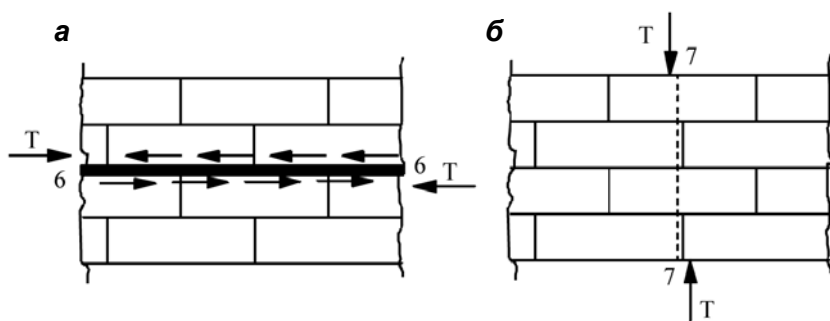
Растяжение кладки при изгибе по перевязанному сечению подпорных стенок
